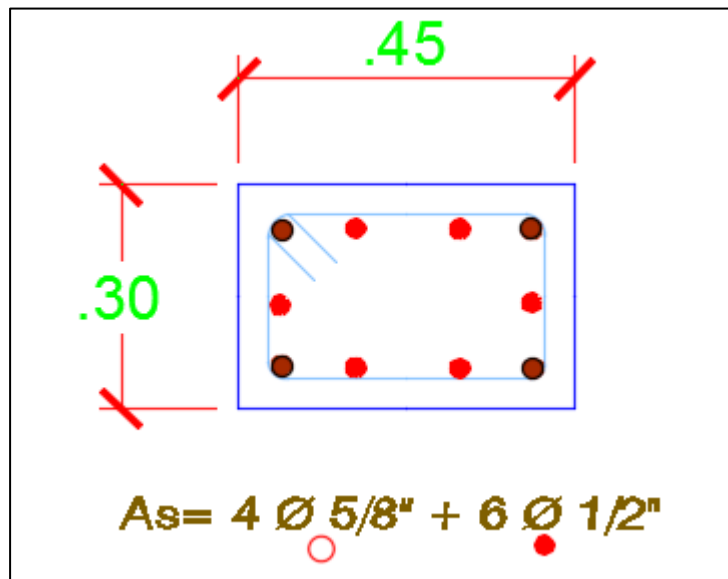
Sección Transversal Columna C-3 x-x. Fuente: Elaboración propia.
